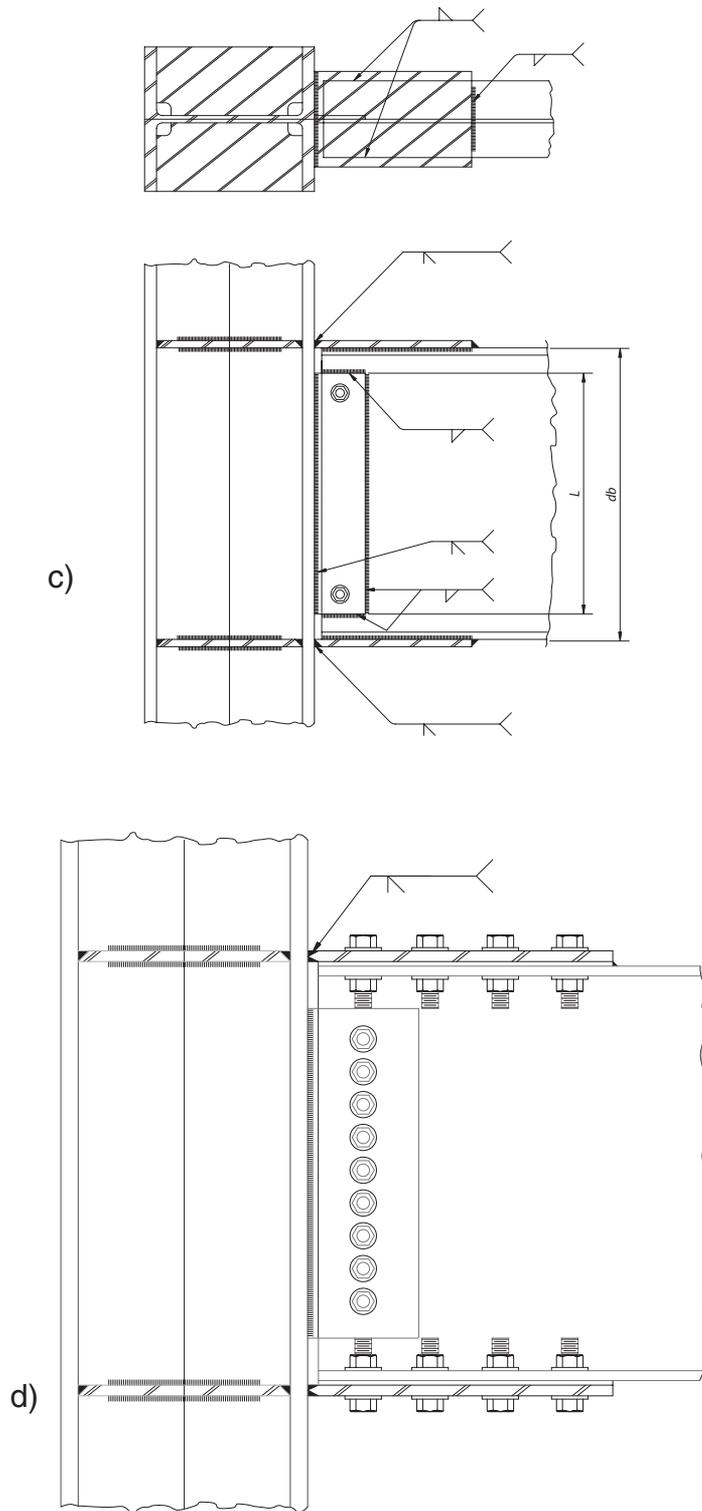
c, d. Uniones viga columna precalificadas, ref.8.
